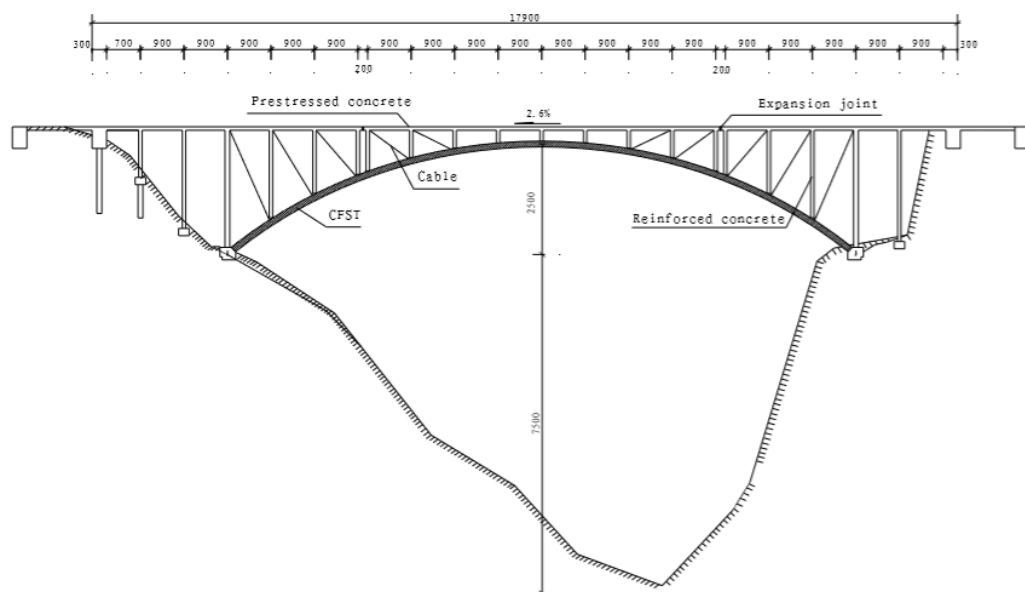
Ubicación de juntas de expansión y contracción en el tablero
